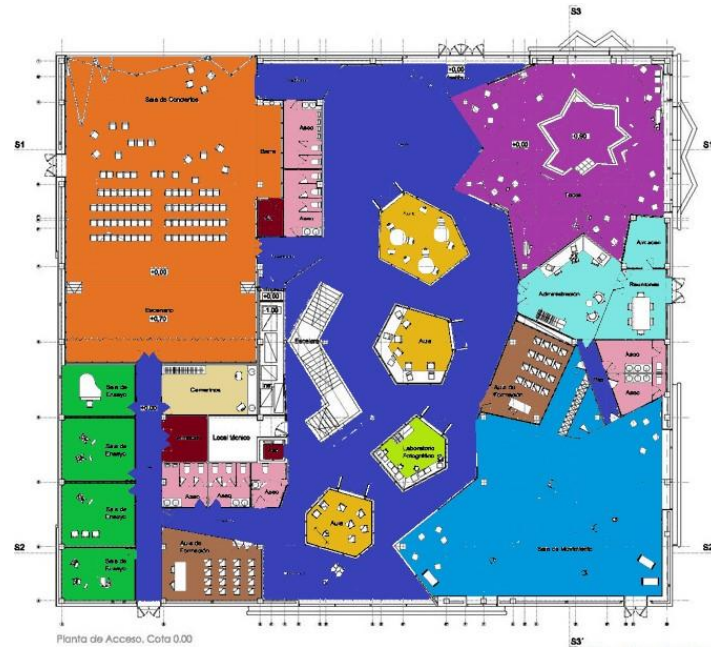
Planta arquitectónica (Guzman, 2010)
